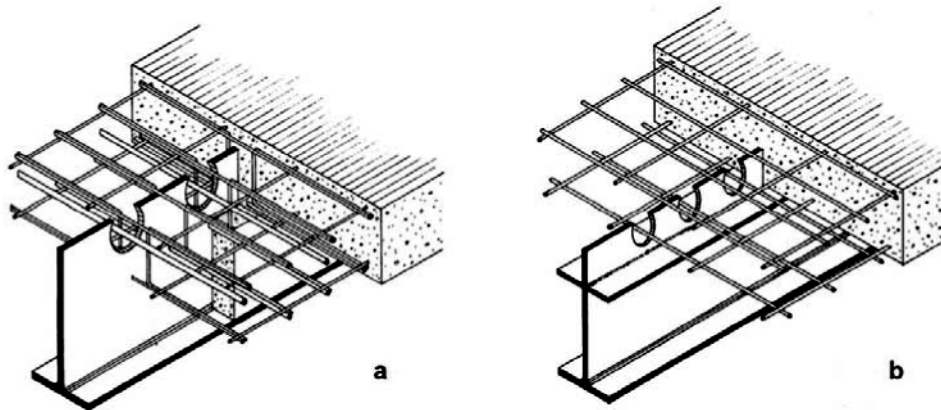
Конструкция объединения бетона и стали [7]: а) в специальной полосе; б) в стенке балки
